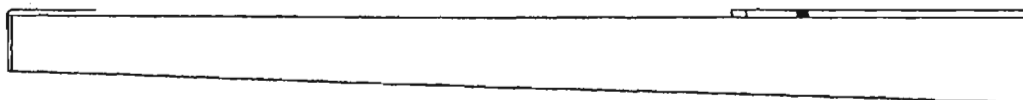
Эскиз предлагаемой железобетонной стойки для опор ВЛ 0,4-10 кВ.
